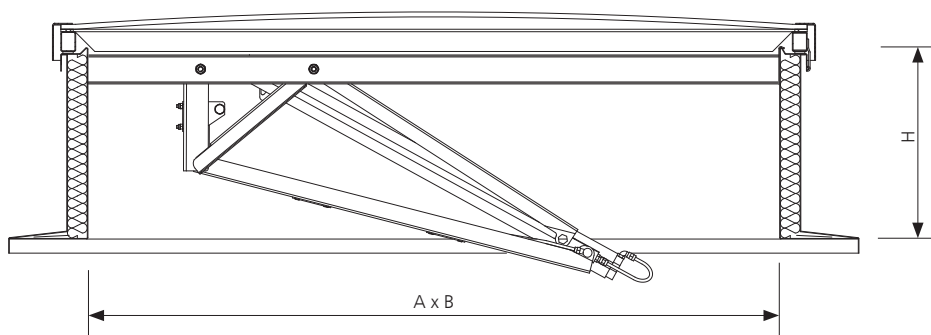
Posadowienie kłap na dachu systemowym typu SANDWICH
